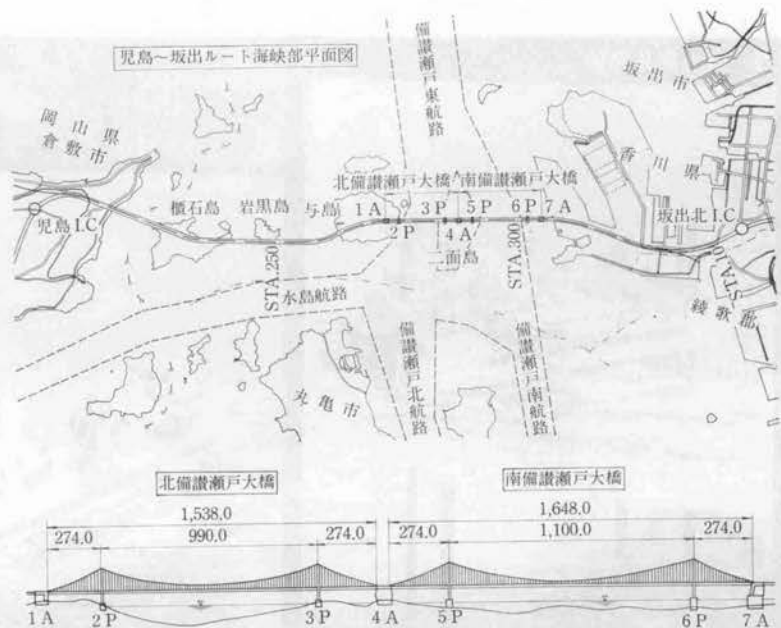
児島～坂出ルート海峡部平面図および南北備讃瀬戸大橋一般図
